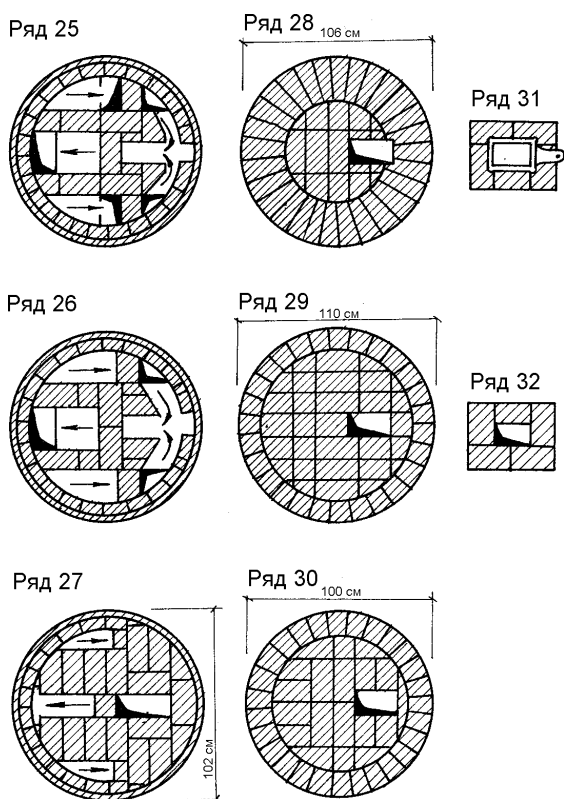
Кладка отопительной круглой печи в металлическом футляре
